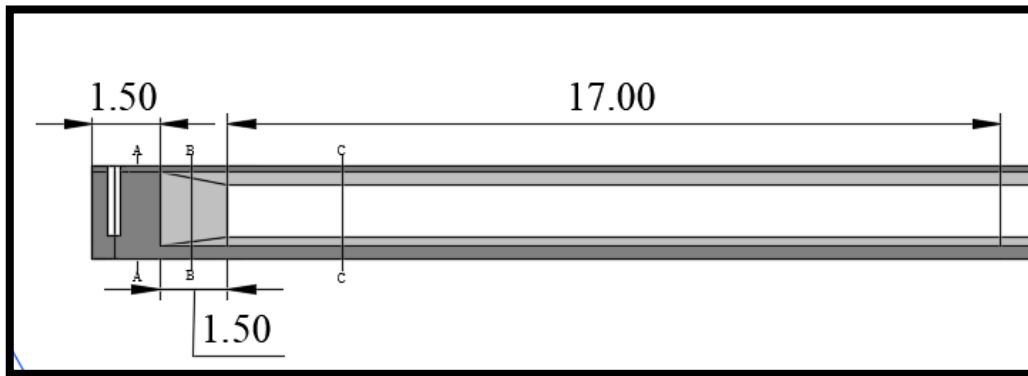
coupe longitudinale d'une demi-travée de la variante N°1
